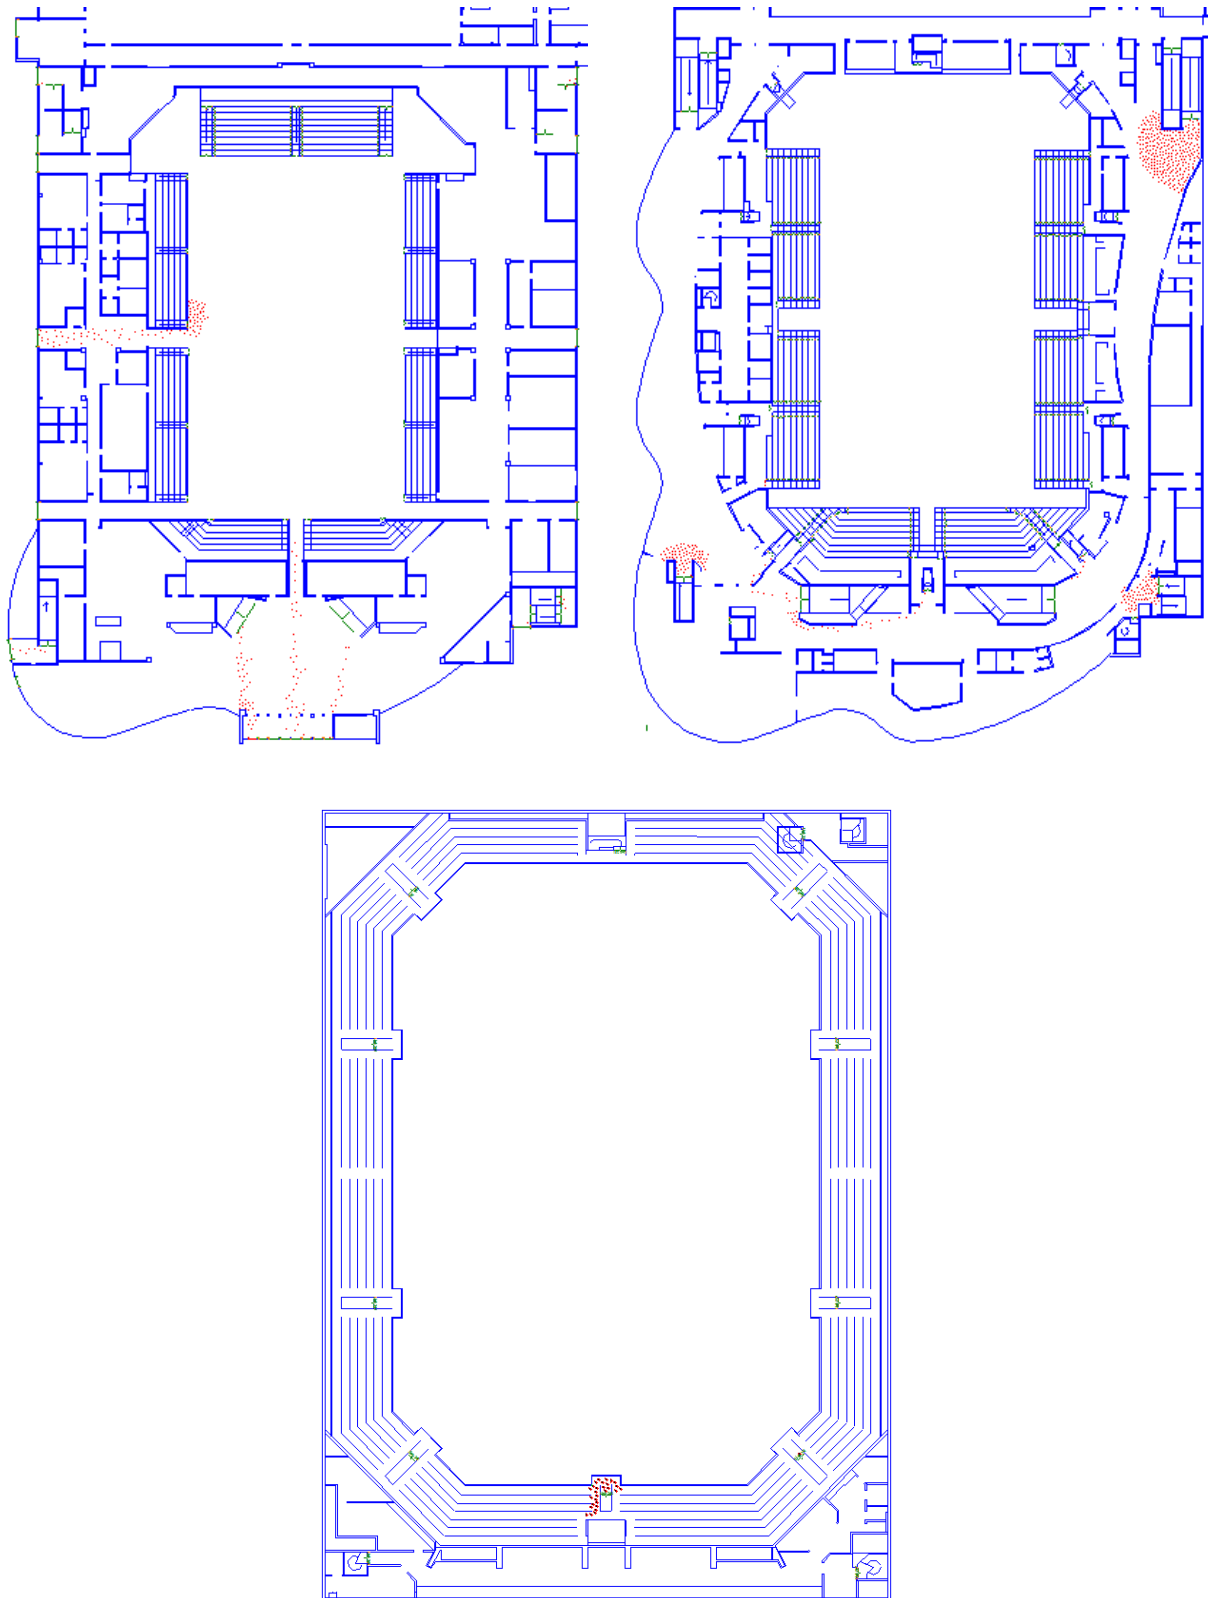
Simuleringens utseende 240 sekunder efter påbörjad utrymning. Plan 1 uppe till höger, plan 2 uppe till vänster och plan 3 nedre bilden.
